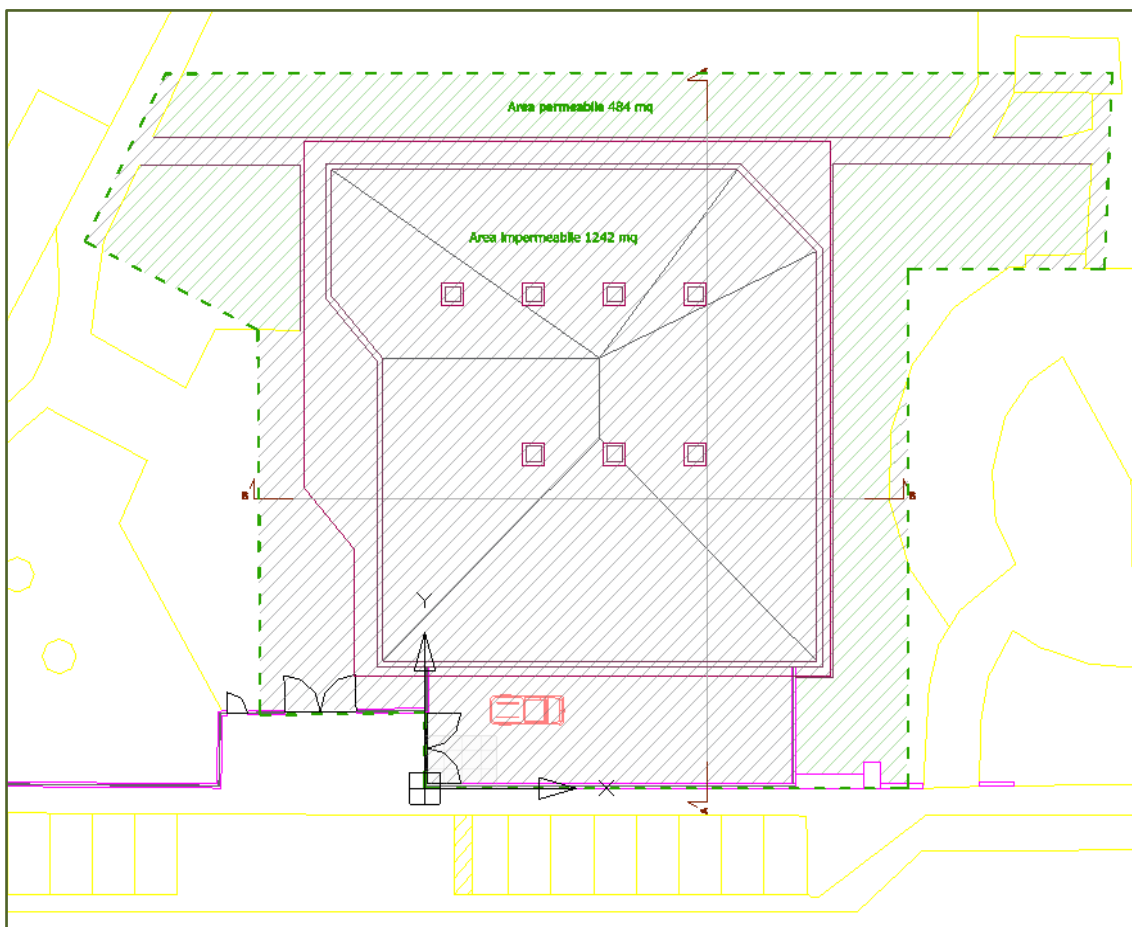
Stralcio planimetrico con indicati le superficie impermeabili/permeabili
